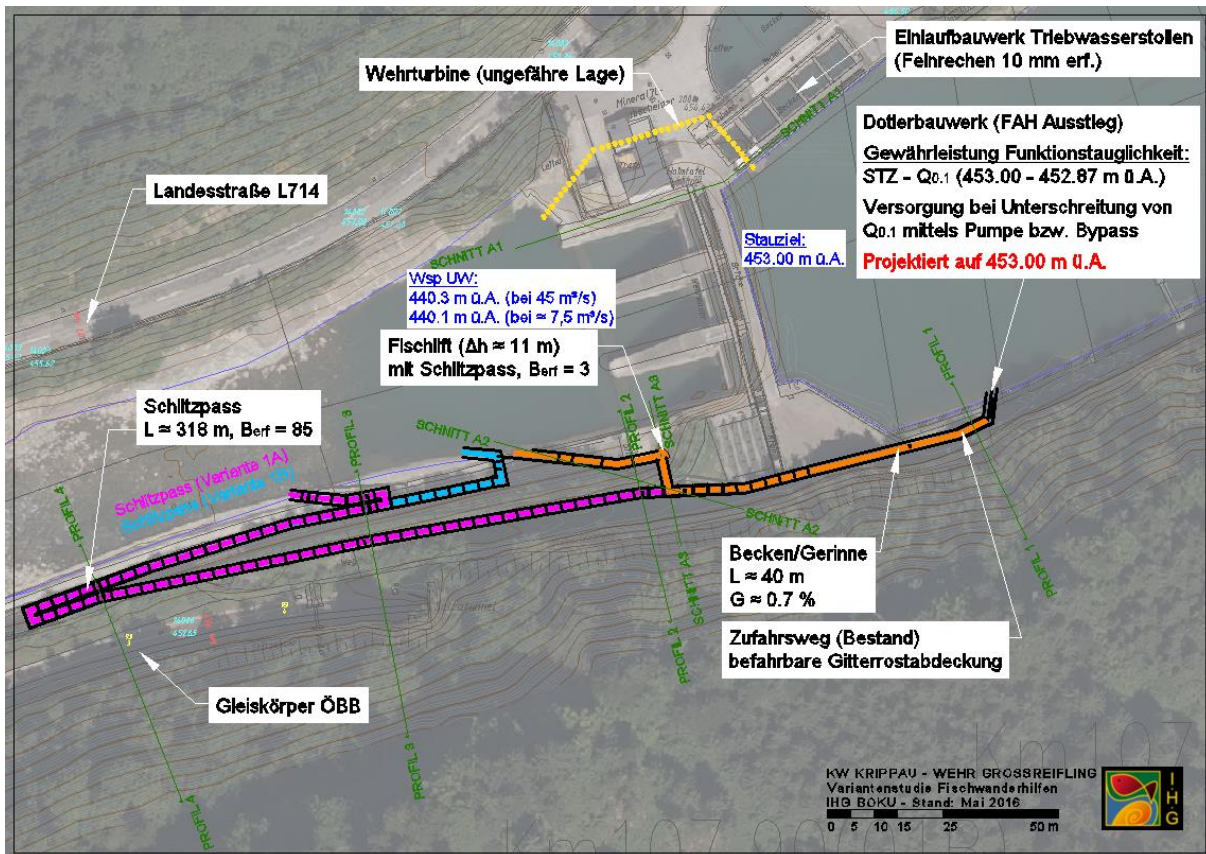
KW Krippau – Variante Schlitzpass (linksufrig) mit zwei Einstiegsvariante (Magenta & Blau) und Variante Fischlift (linksufrig (Orange))
